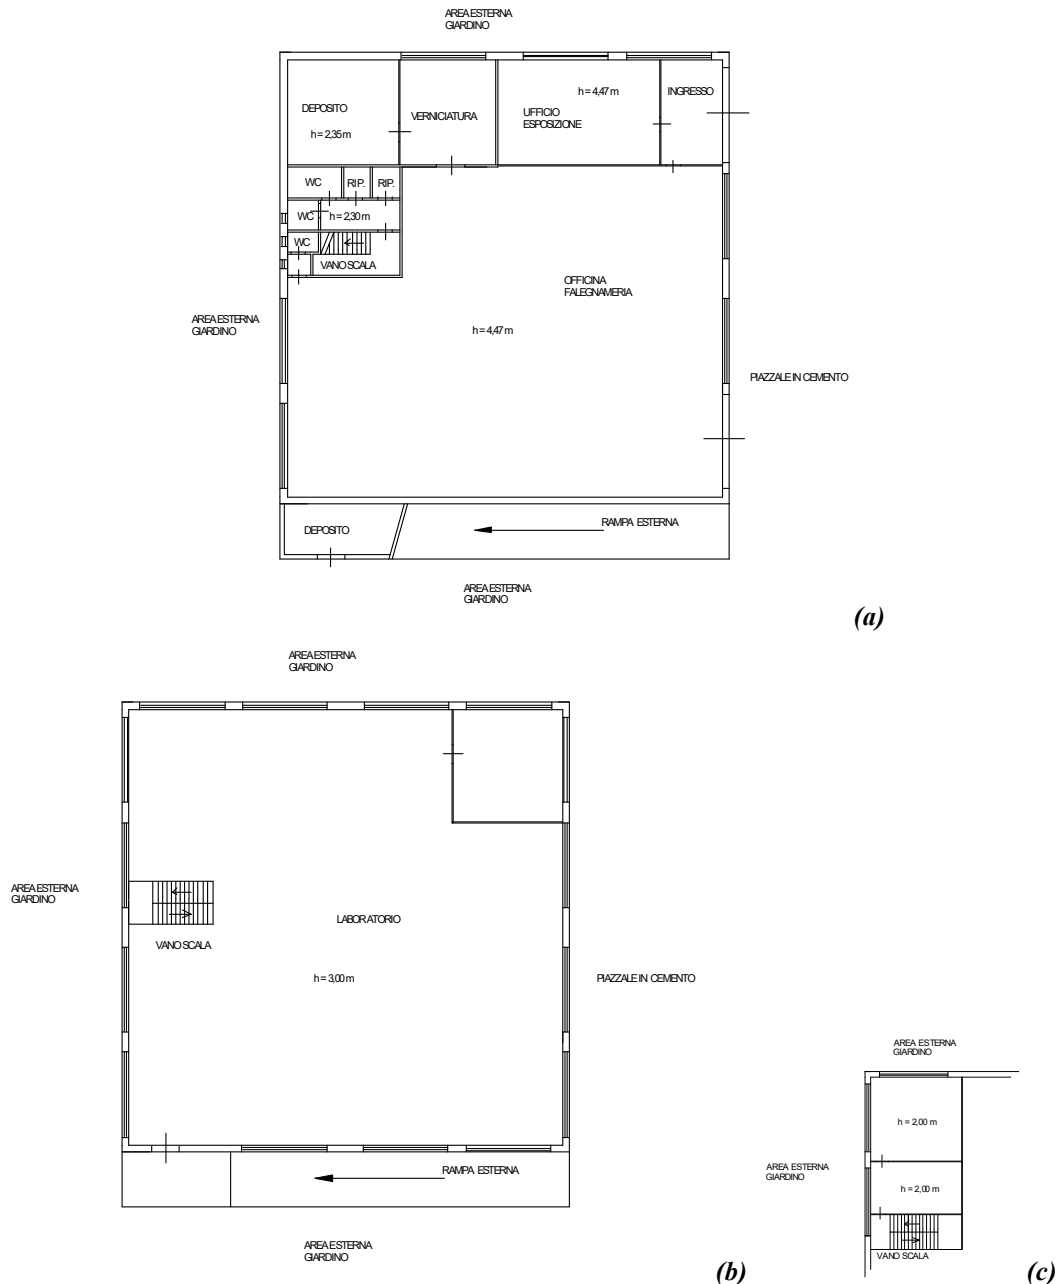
Planimetrie attuali del capannone: piano terra (a); piano primo (b); piano intermedio-soppalco (c).
